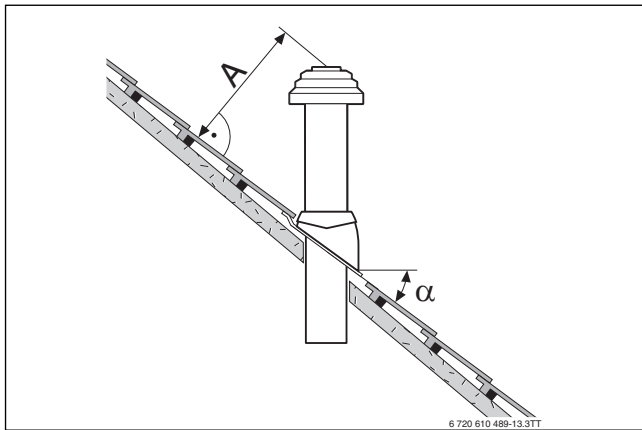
Abstandsmaße und Dachneigungen bei Schrägdach
